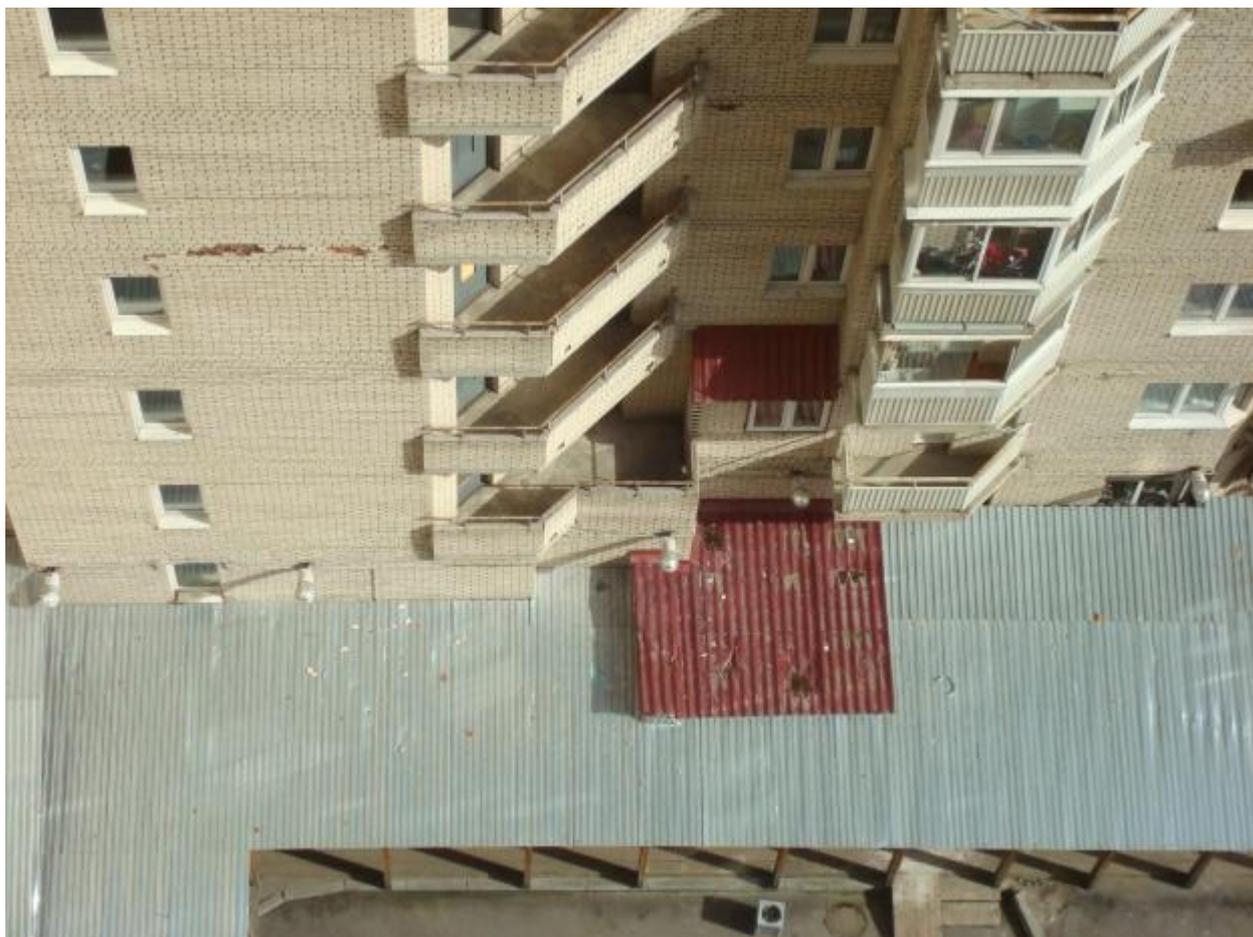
Установка защитных навесов вдоль фасада здания
